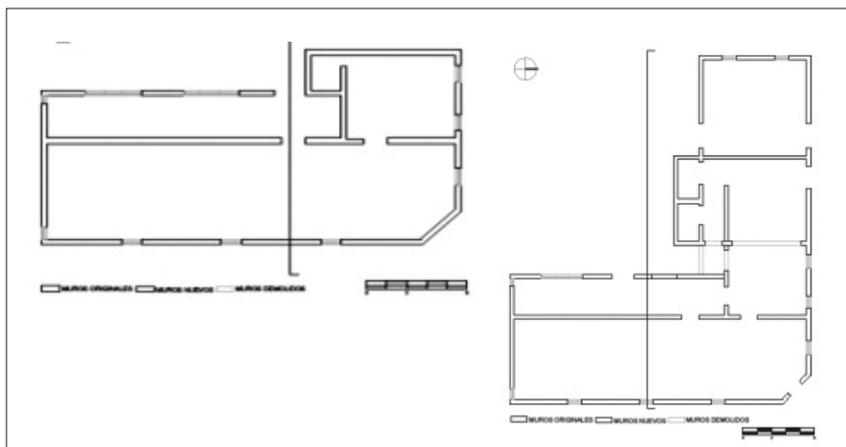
Biblioteca Domingo Silva. Planta del elevamiento realizado en tesis de grado FADU–UNL, 1989. Plano actual de la Biblioteca, 2019
